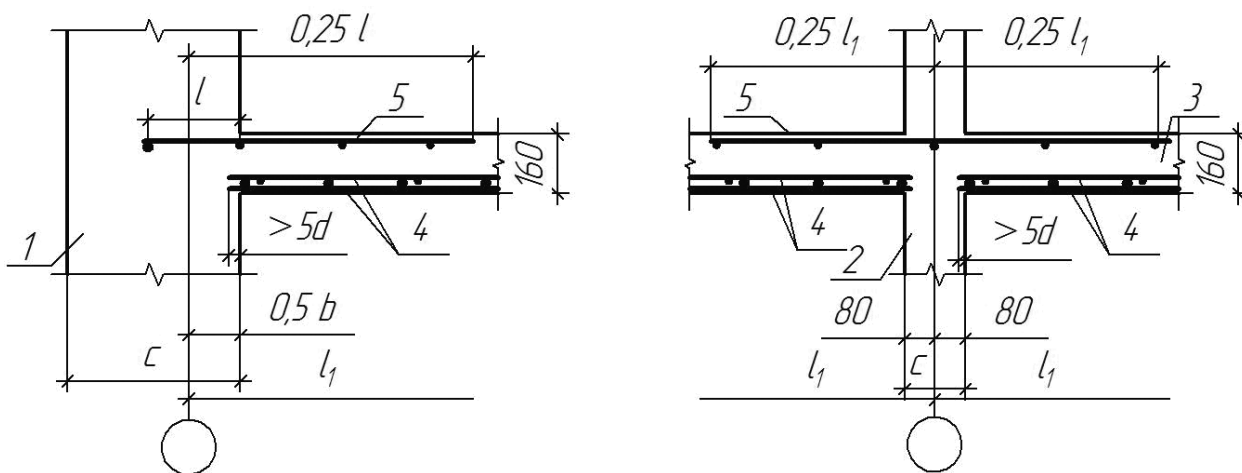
Монолитные ненарезные перекрытия, защемленные в наружных и внутренних стенах при контактных сопряжениях: 1 – наружная стена; 2 – внутренняя стена;
